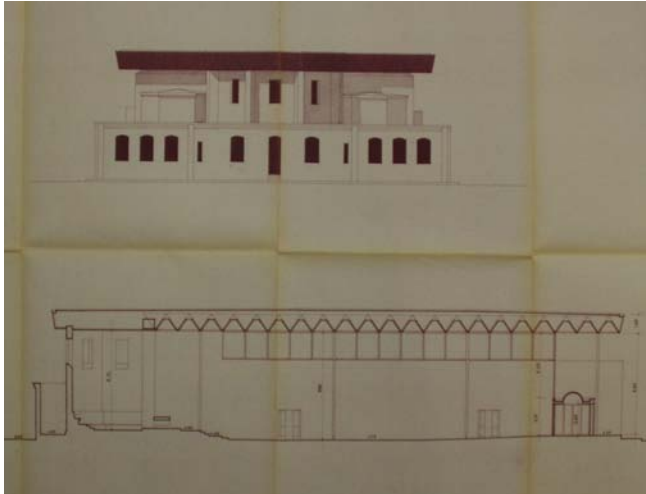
Façade postérieure, coupe longitudinale 28-06-61 (AHDL P 250)
